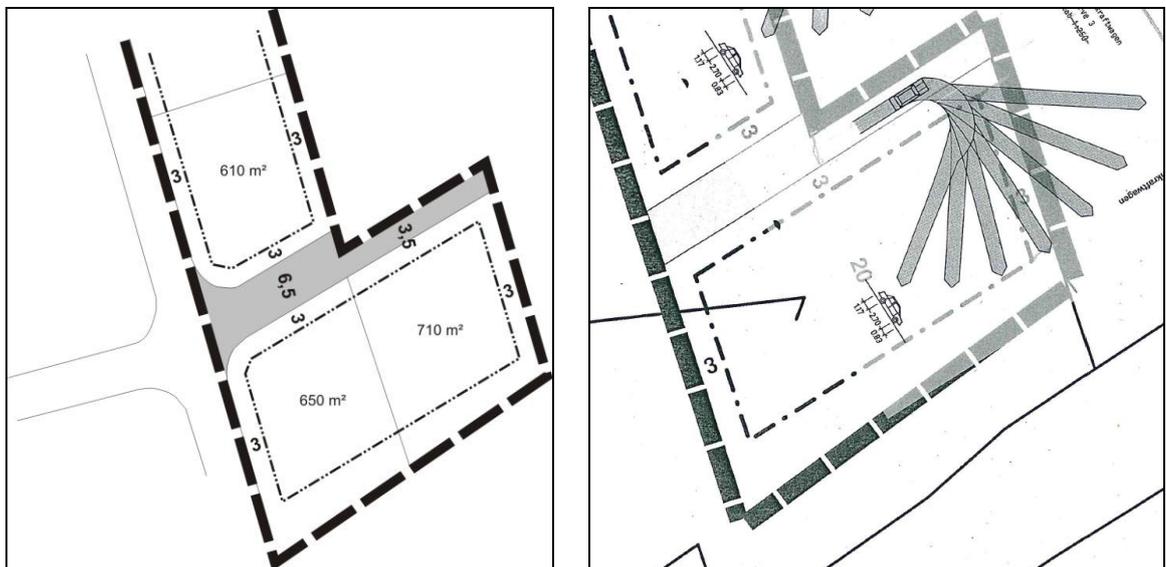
, links: Entwurf Planzeichnung, südöstlicher Bereich mit Parzellierungsvorschlag
